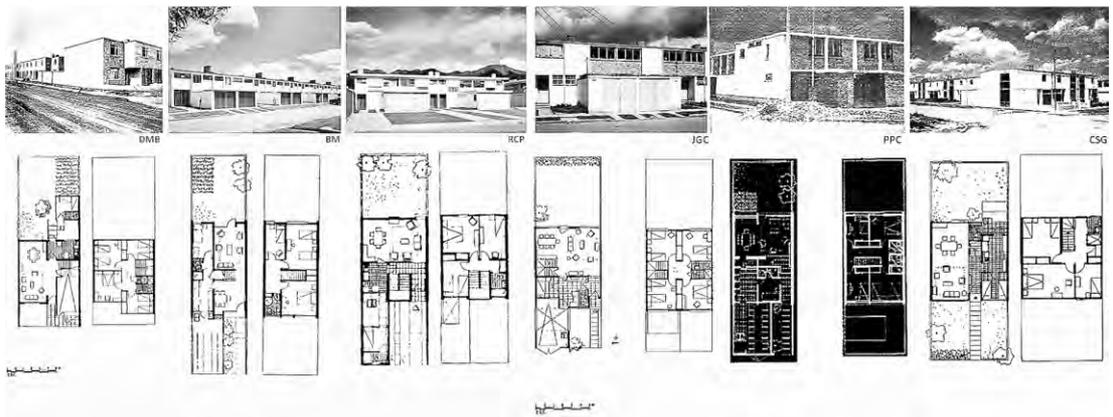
Casas tipo Quinta Mutis. Revista PROA, (noviembre, 1955,) 94, s.p.
